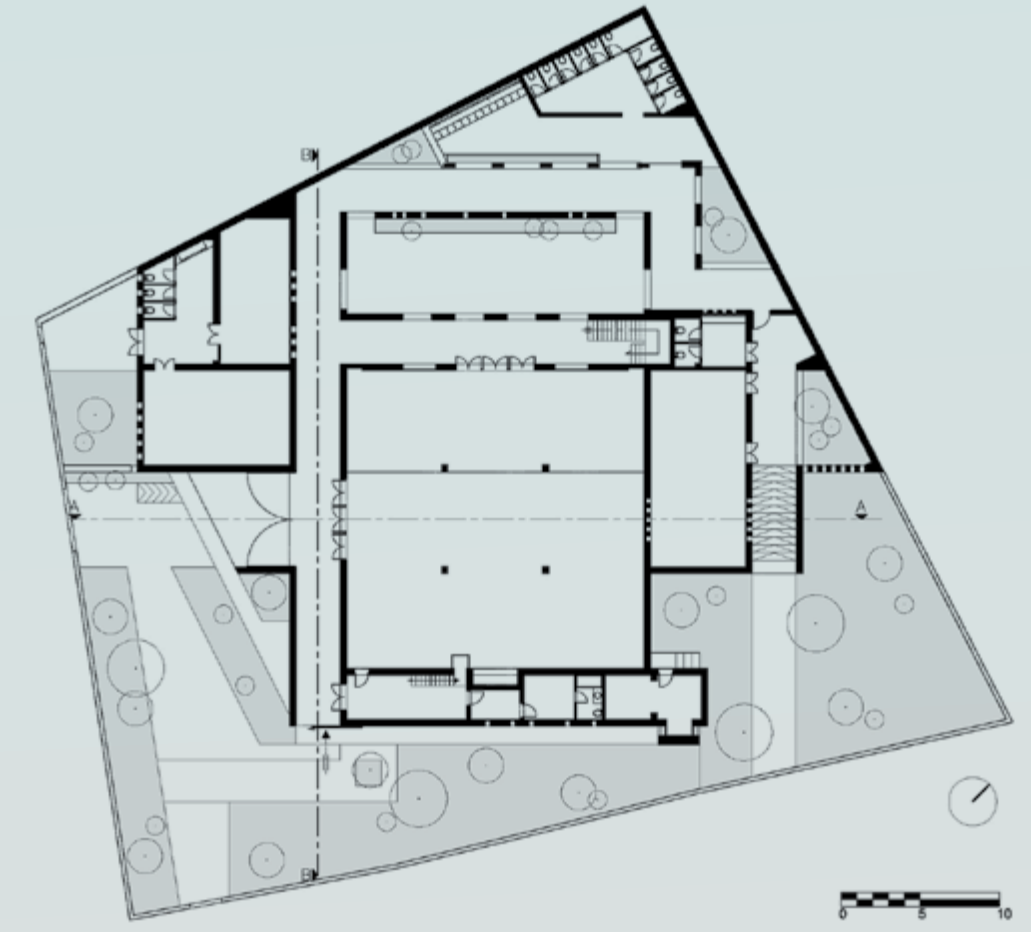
المسقط الأفقي للطابق الأرضي.
